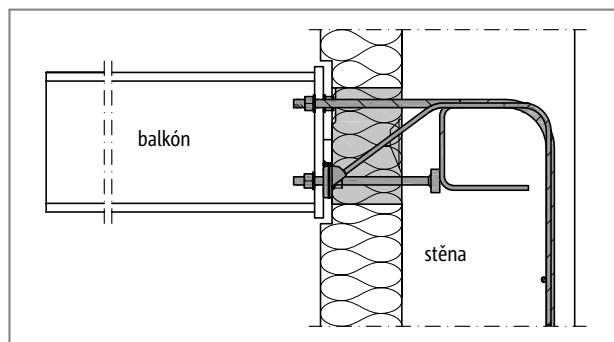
Schöck Isokorb® XT typ SKP: Napojení na železobetonovou stropní desku; izolant uvnitř vnějšího zateplení
